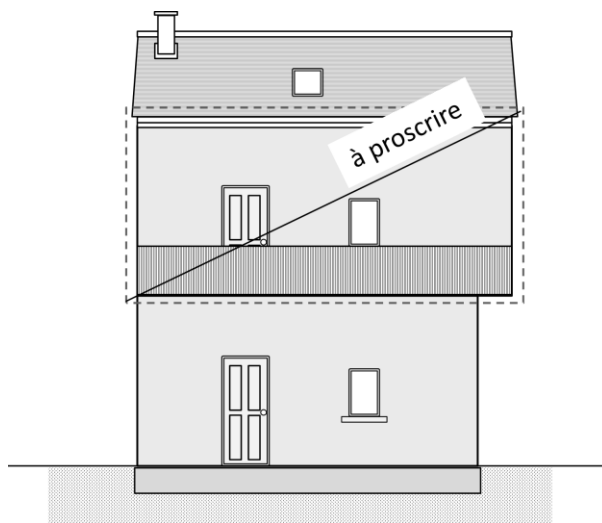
exemple du porte-à-faux engendré par la surélévation d'un niveau (à proscrire)
